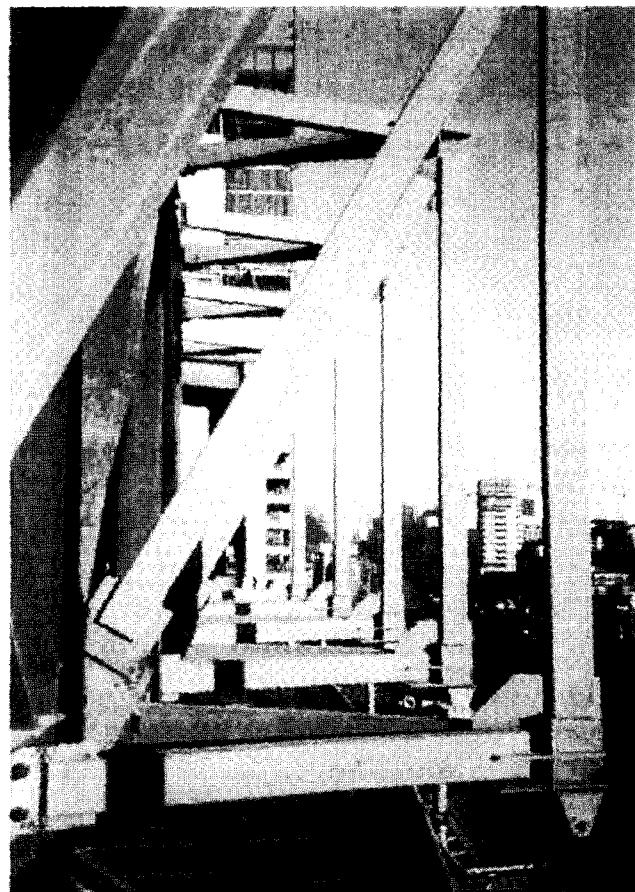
Horizontal Wind Truss 설치용 상부 구조체 설치
